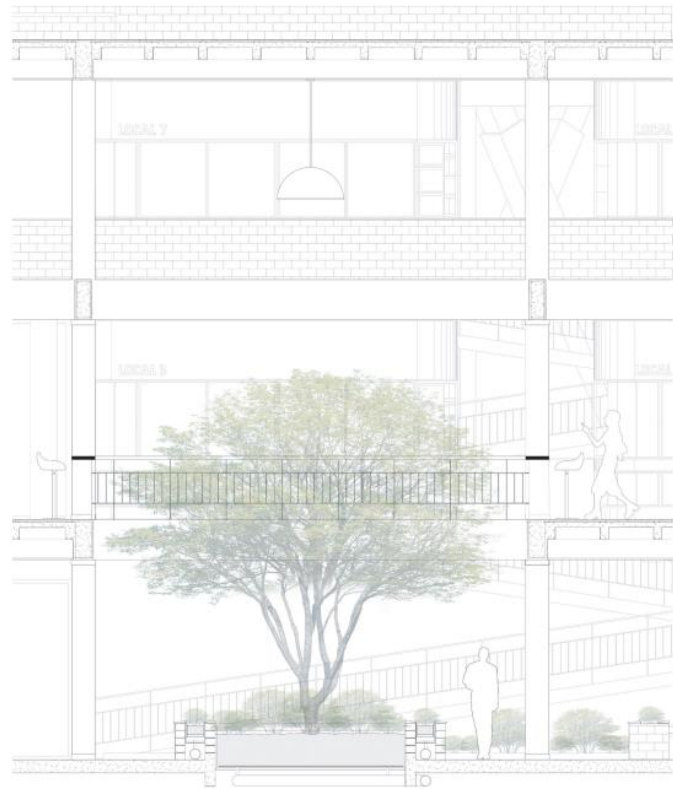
Planta Ampliación – zona social locales comerciales. Por: Elaboración propia.
